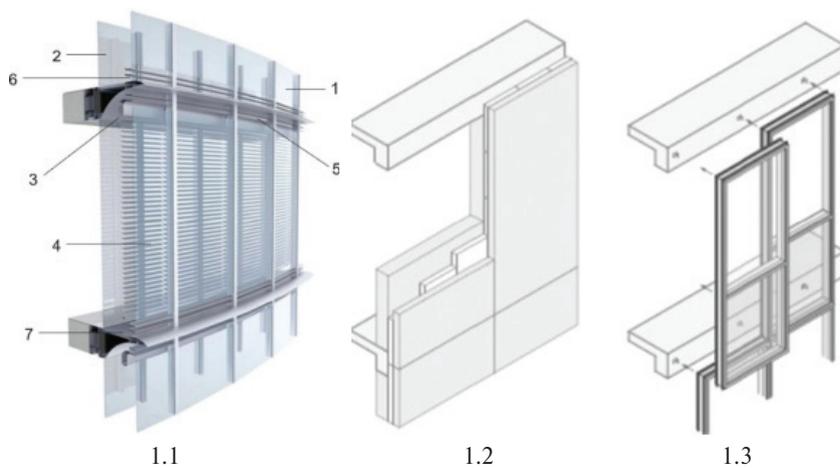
1.1 – Конструкция двойного стержневого фасада;
